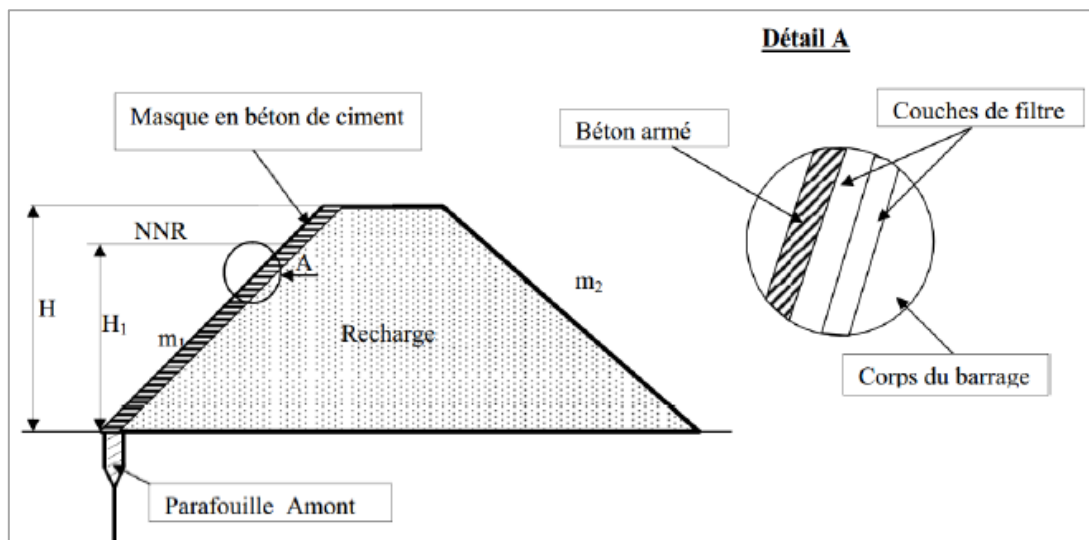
Masque amont en béton de ciment (MESSAID, 2009)
